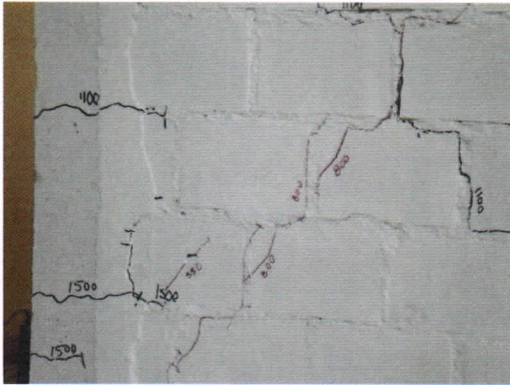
Aparición de nuevas grietas en el ladrillo en las caras Norte y Sur para una distorsión de 1/550.
